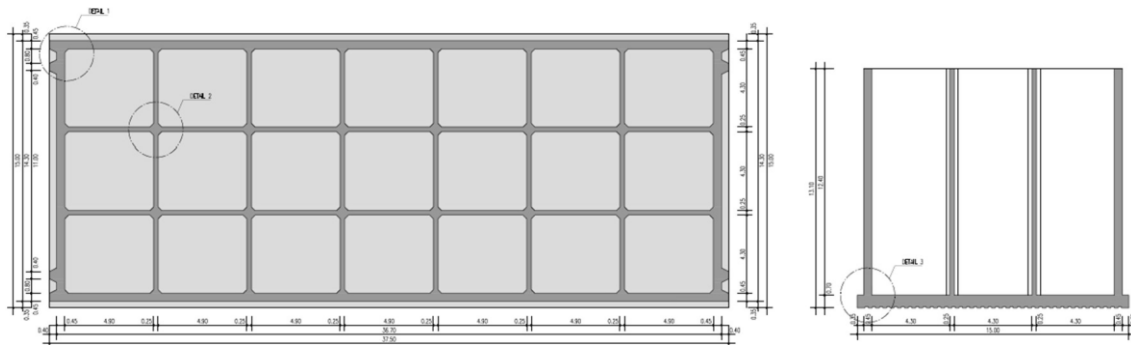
Caixotões pré-fabricados. Planta e perfil tipo.
